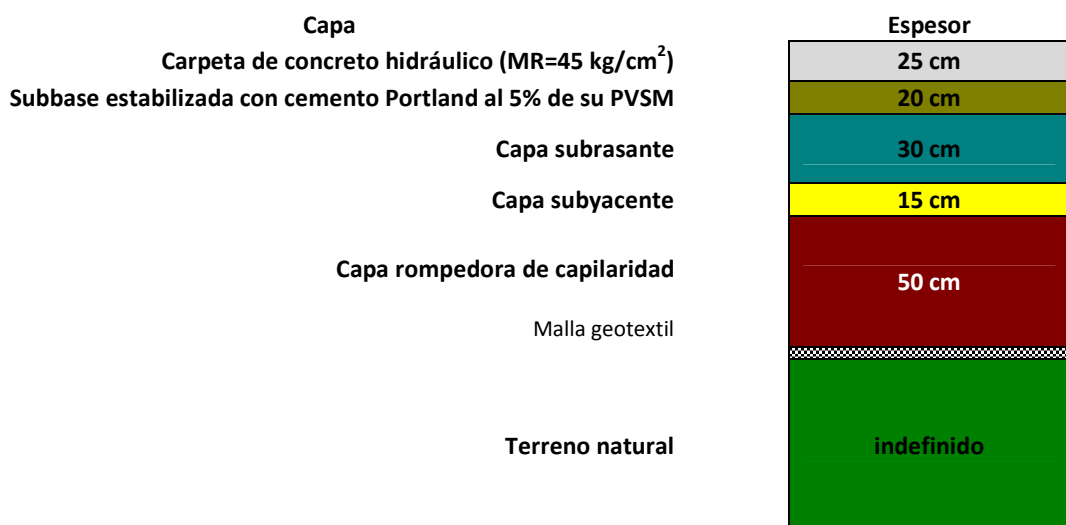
Sección de proyecto a construir para el tramo con capa rompedora de capilaridad.
